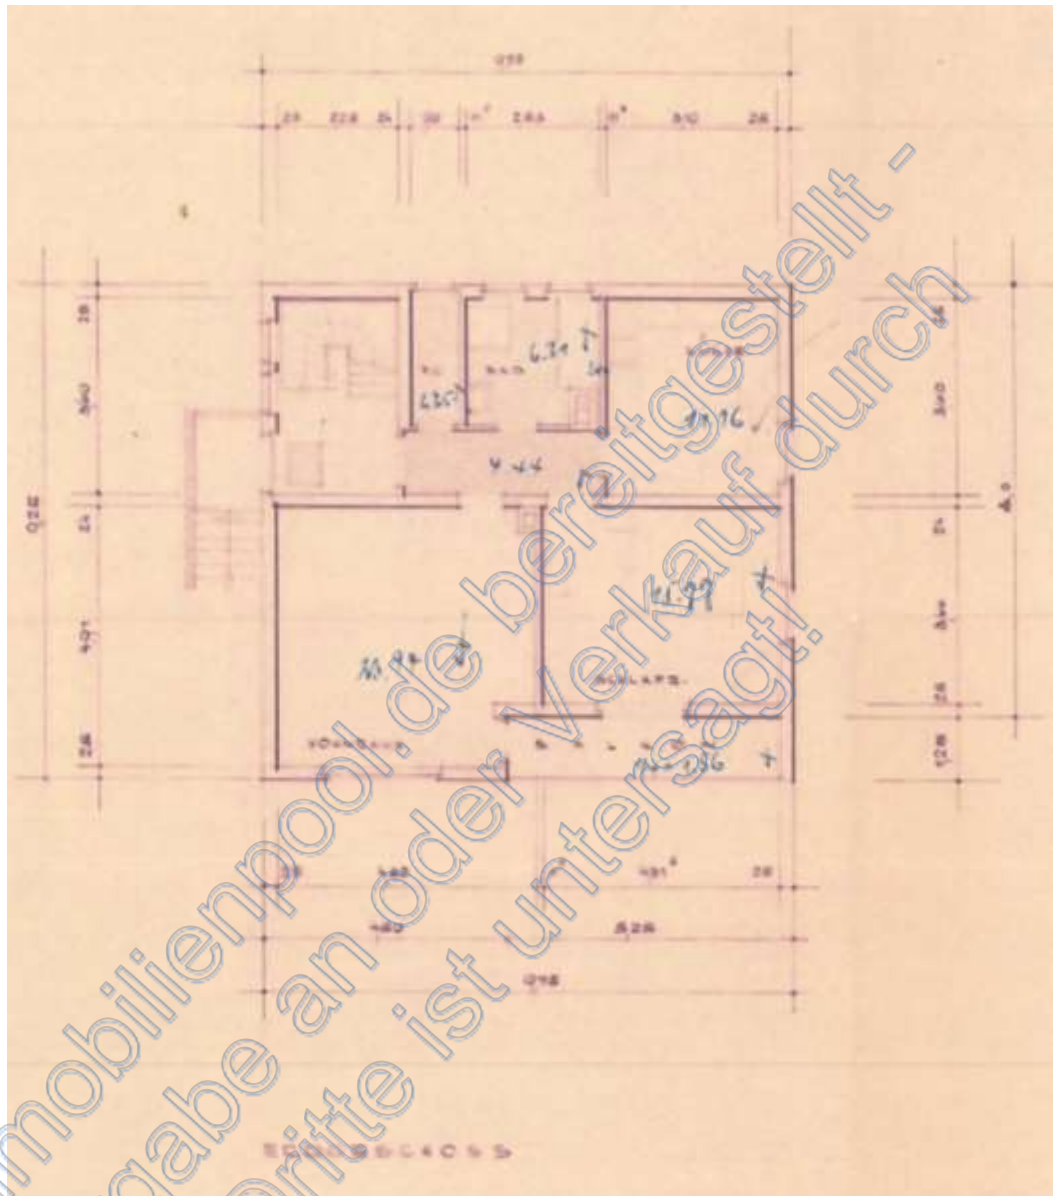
Bauzeichnung: Grundriss Erdgeschoss
